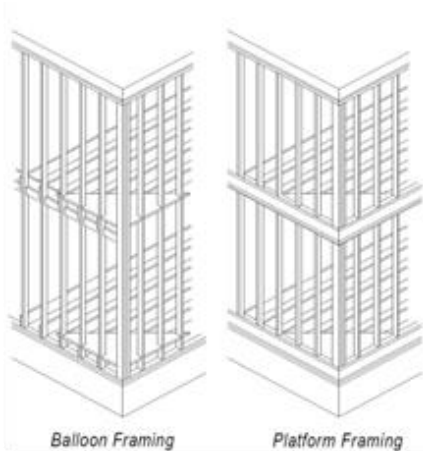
, Pared sistema constructivo Drywall. (Fuente disponible en: SFA.)
